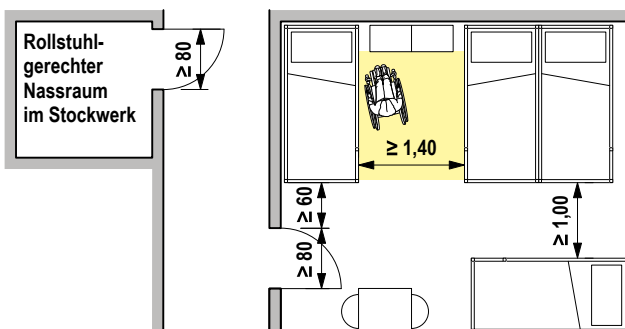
Beispiel einer Zimmerausstattung mit den minimal erforderlichen Manövrierflächen.
